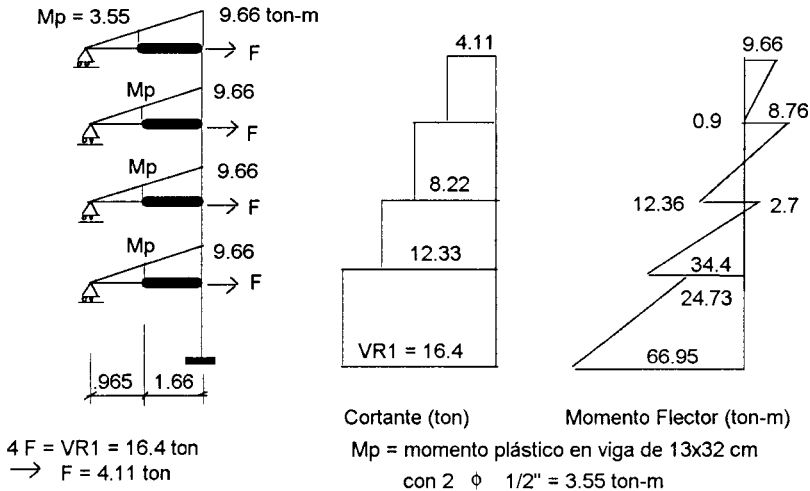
Distribución de esfuerzos en el Muro X4, asumiendo rótulas plásticas en las vigas y una distribución uniforme de las fuerzas de inercia al agrietarse el primer piso.
